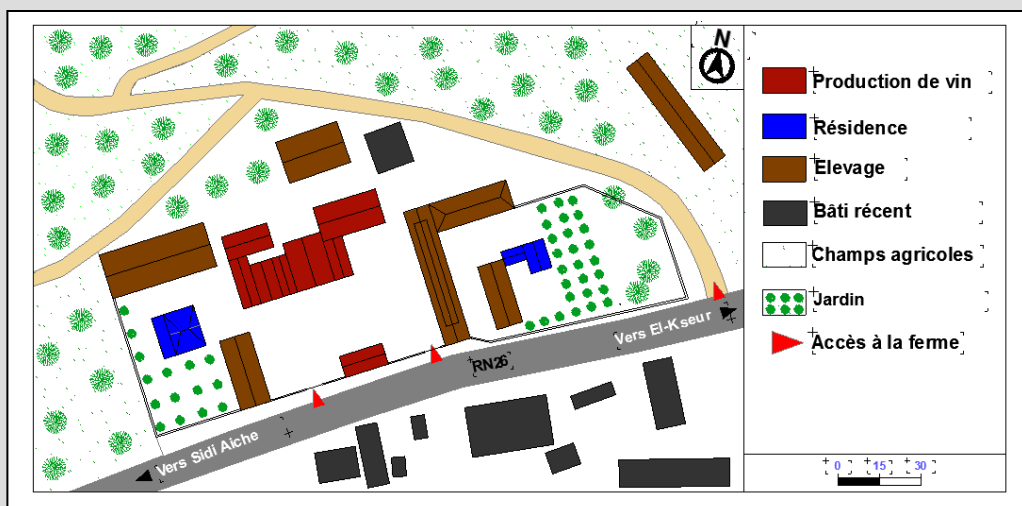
Plan de masse Domaine Benyoub Mahmoud
